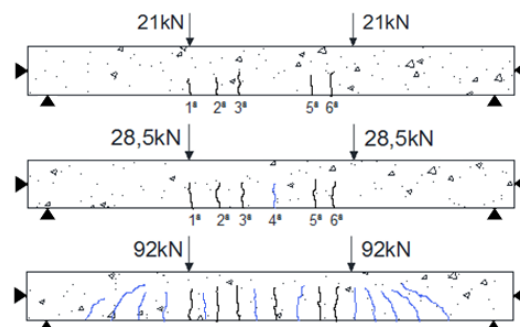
Formação e evolução das fissuras da Viga4old.
